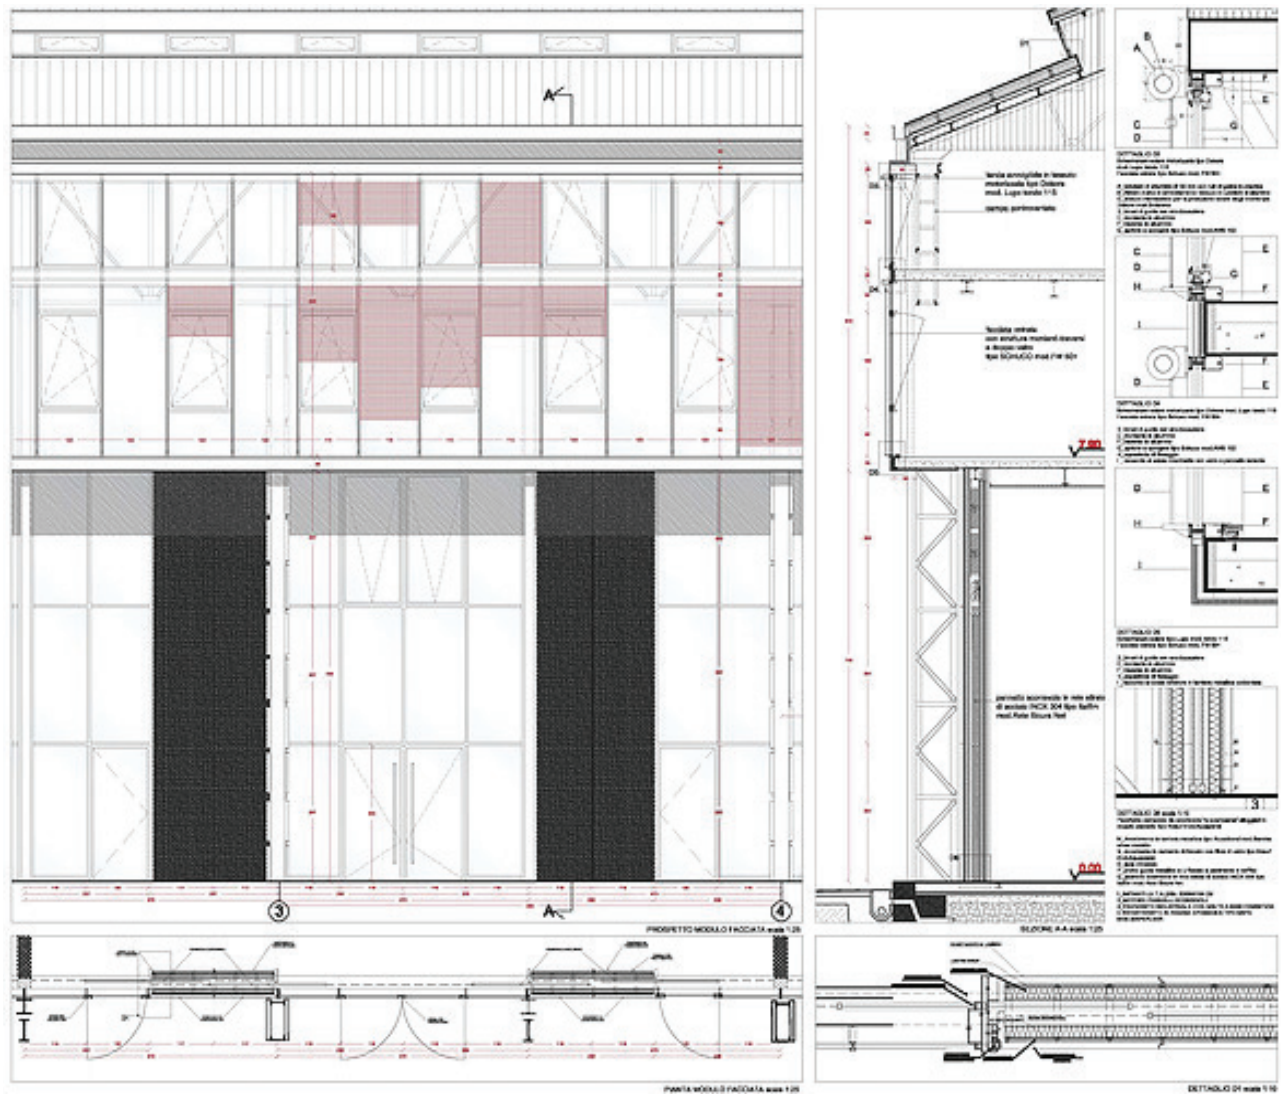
Prospetto, pianta e sezione tecnologica e dettagli costruttivi; Fonte: <https://www.vulcanicaarchitettura.com/>;
